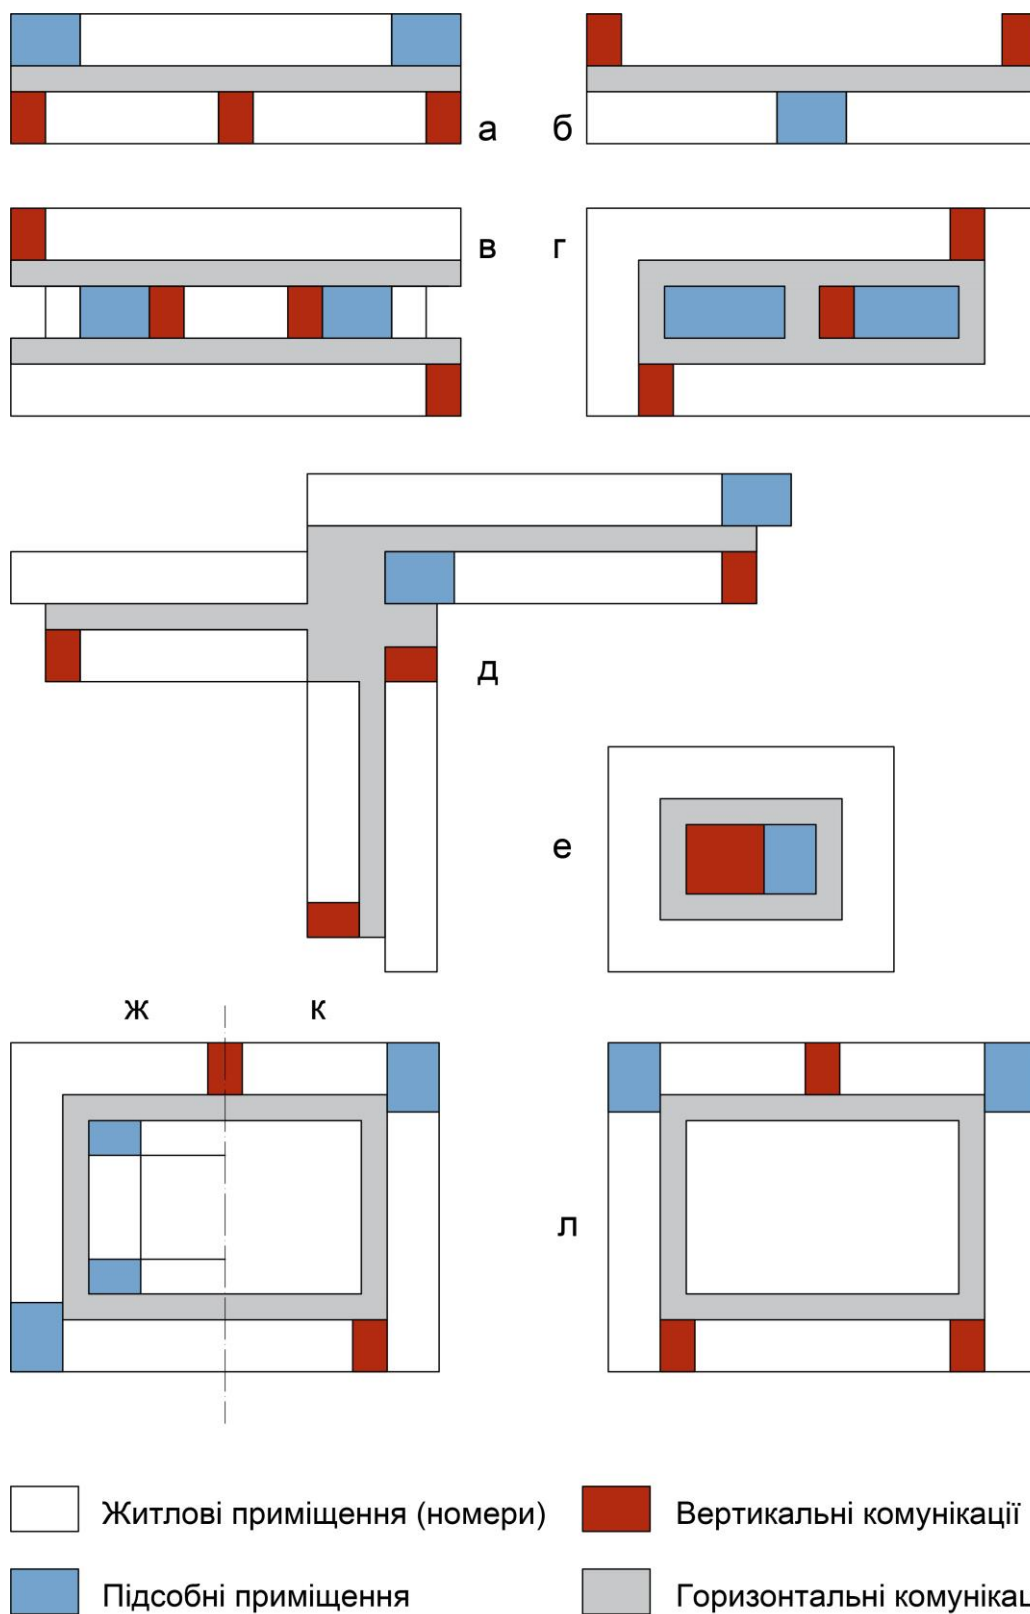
Планувальні схеми житлових поверхів готелів:
